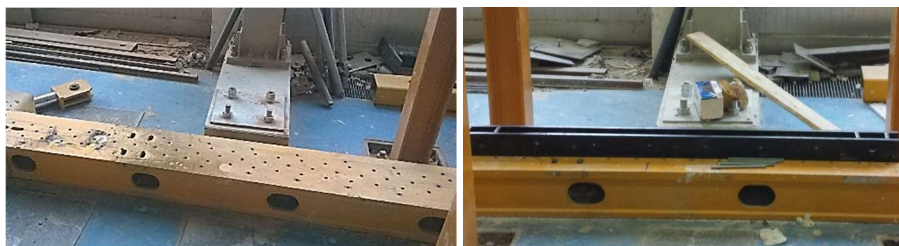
Scatolare cavo in acciaio e traversa fissata
